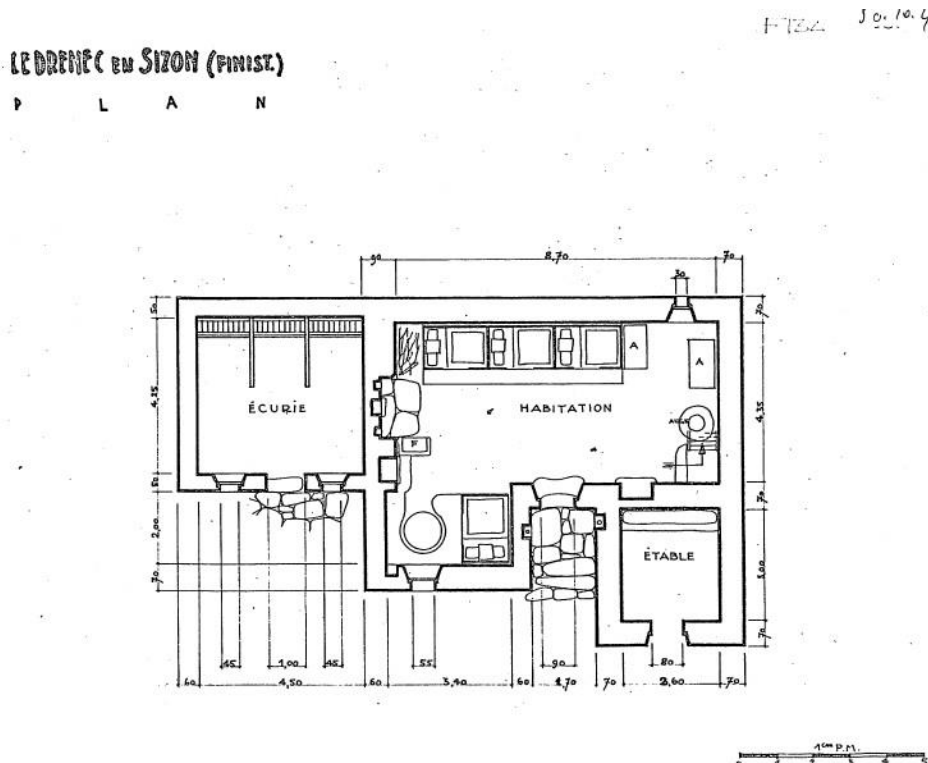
Plan d'une maison de ferme, Sizun. Chantier 1445.
